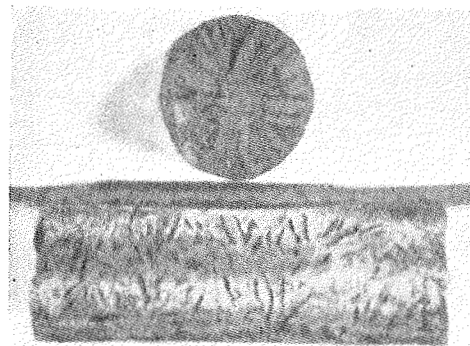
Vigas inyectadas, sometidas a la acción de la helada.
